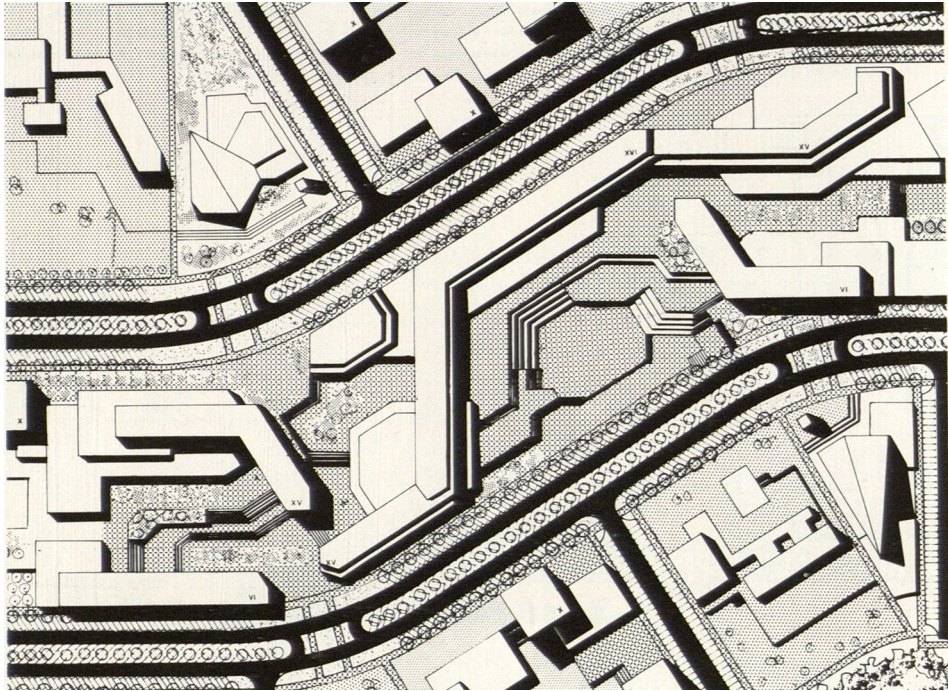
Plano general Plan Parcial Sardanyola. Fuente: «Revista Arquitectura», 94 pp. 43-48.
